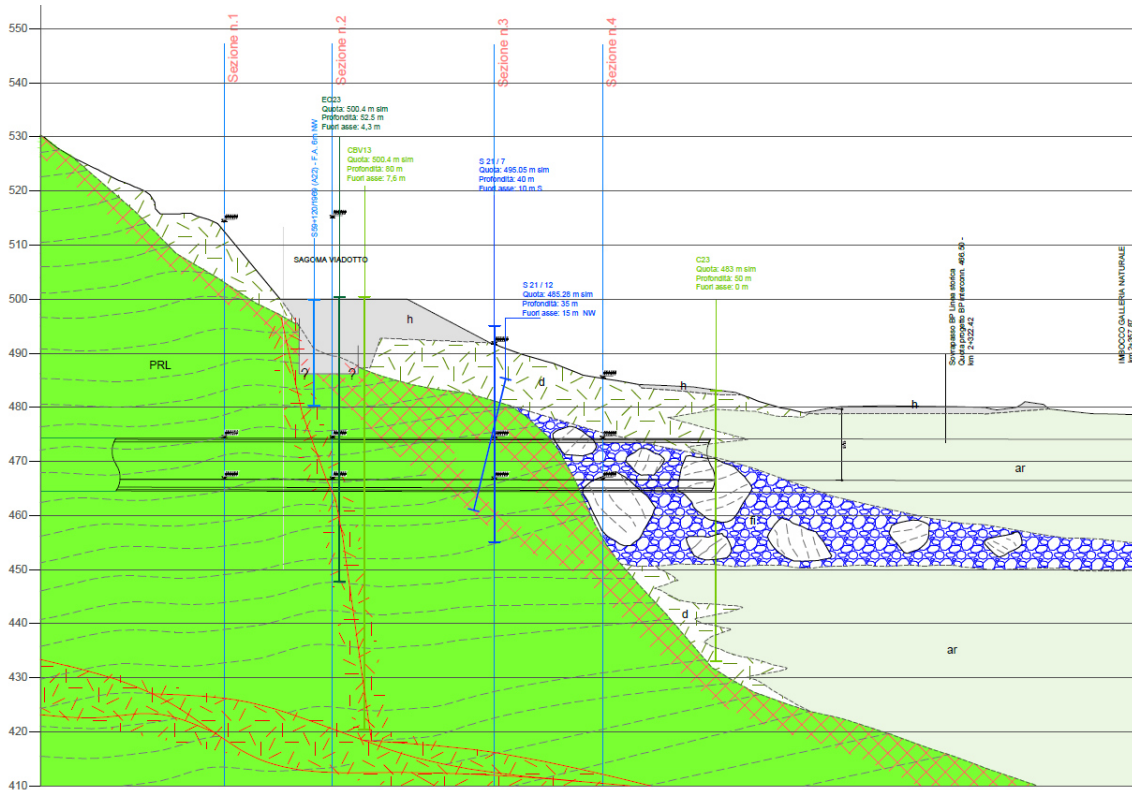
Stralcio del planoprofilo di dettaglio dell'imbotto dell'interconnessione di Ponte Gardena – binario pari con la sezione longitudinale lungo il tracciato - elaborato IBOU1BEZZL7GE0001005B.
